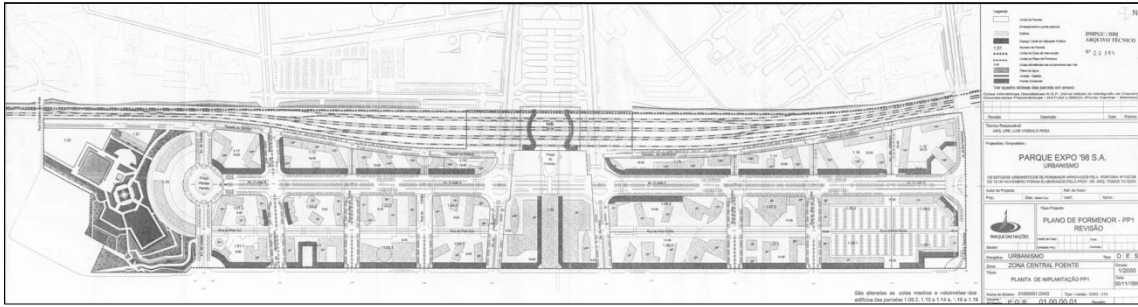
Planta do Plano de Pormenor n.º1: Zona da Plataforma Panorâmica
